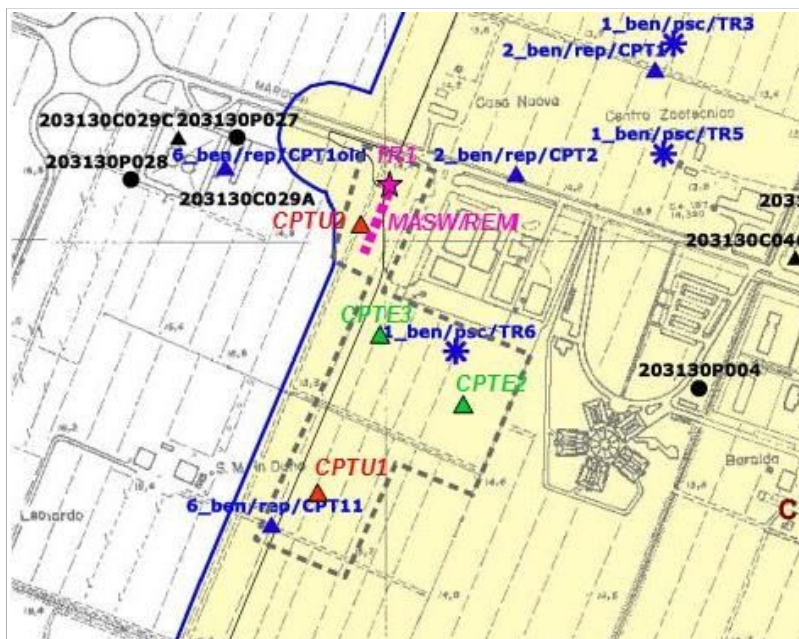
Sovrapposizione delle indagini geognostiche/geofisiche (eseguite nell'area di studio) con la planimetria di progetto del primo stralcio attuativo
